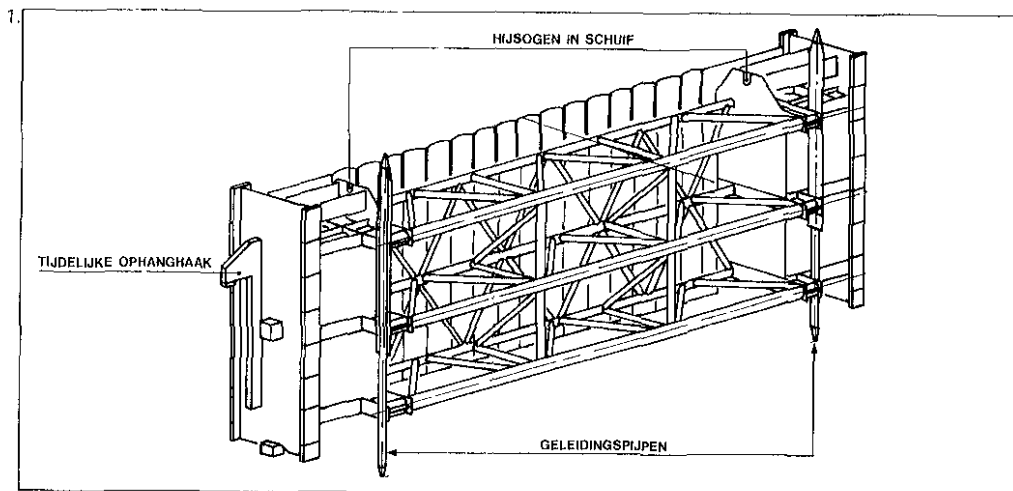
Schuif met tijdelijke voorzieningen ten behoeve van de plaatsing
